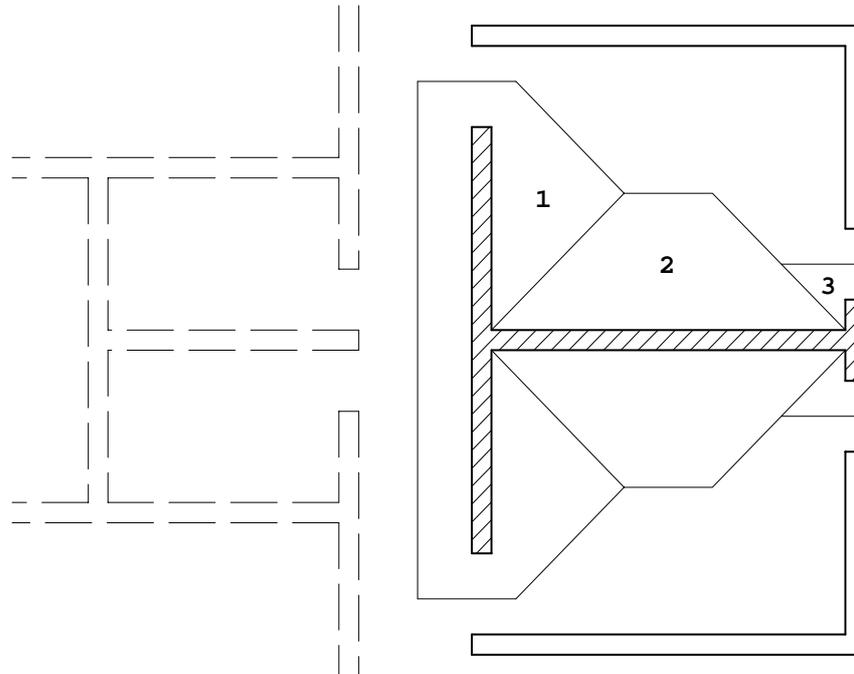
Distribuição das cargas das lajes para as paredes resistentes.
